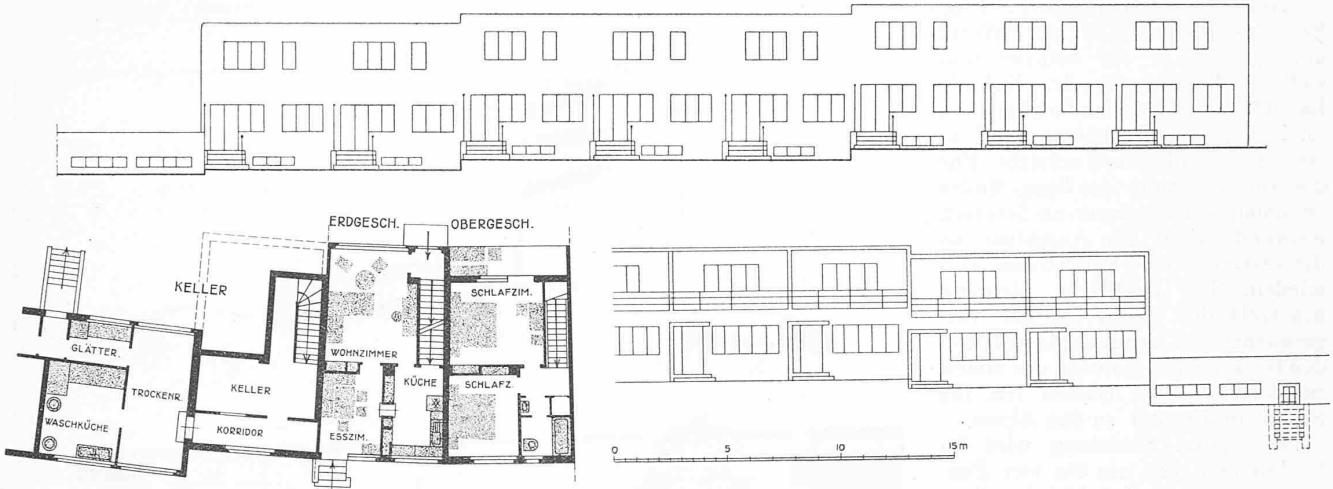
Typ C, Einfamilien-Reihenhaus mit vier Zimmern, Wohnraum 4,93 x 4,18 m. Oben Ostfassade, darunter Grundrisse und Westfassade, Masstab 1 : 300.
